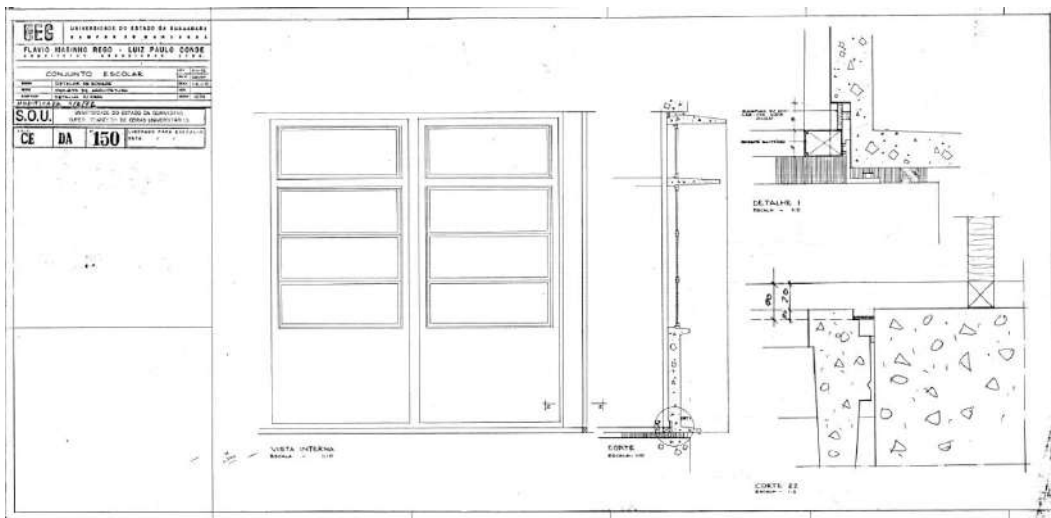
UERJ. Conjunto Escolar. Painel de fachada com esquadria. Detalhe do rodapé.
